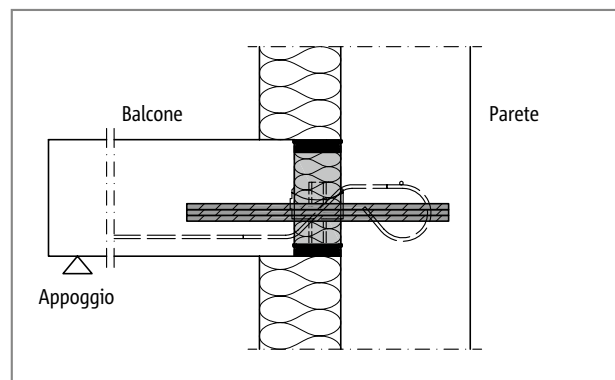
Schöck Isokorb® T tipo QL, HP-VV-NN: raccordo di una parete in calcestruzzo armato con isolamento esterno
